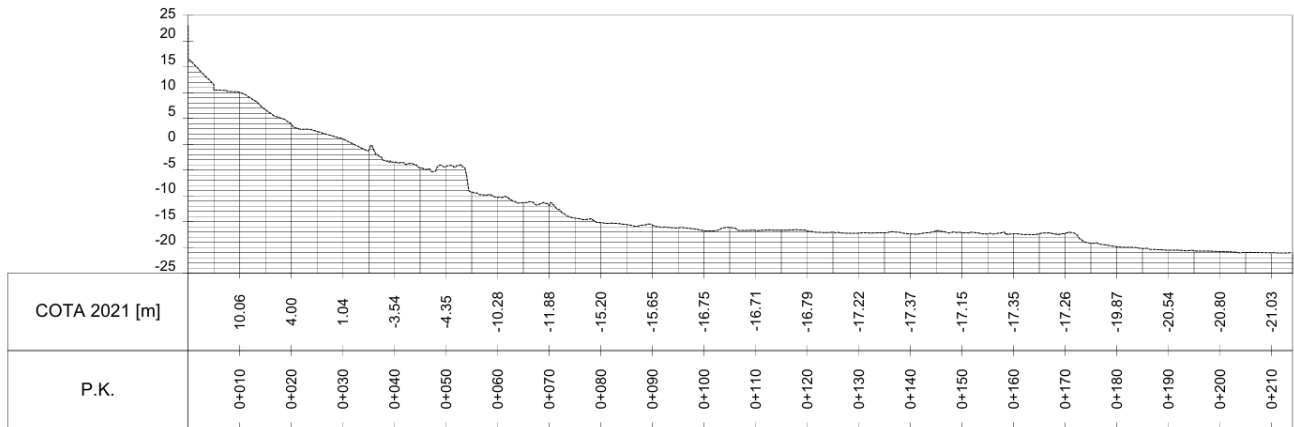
Perfil transversal en la situación posterior al desmoronamiento.
